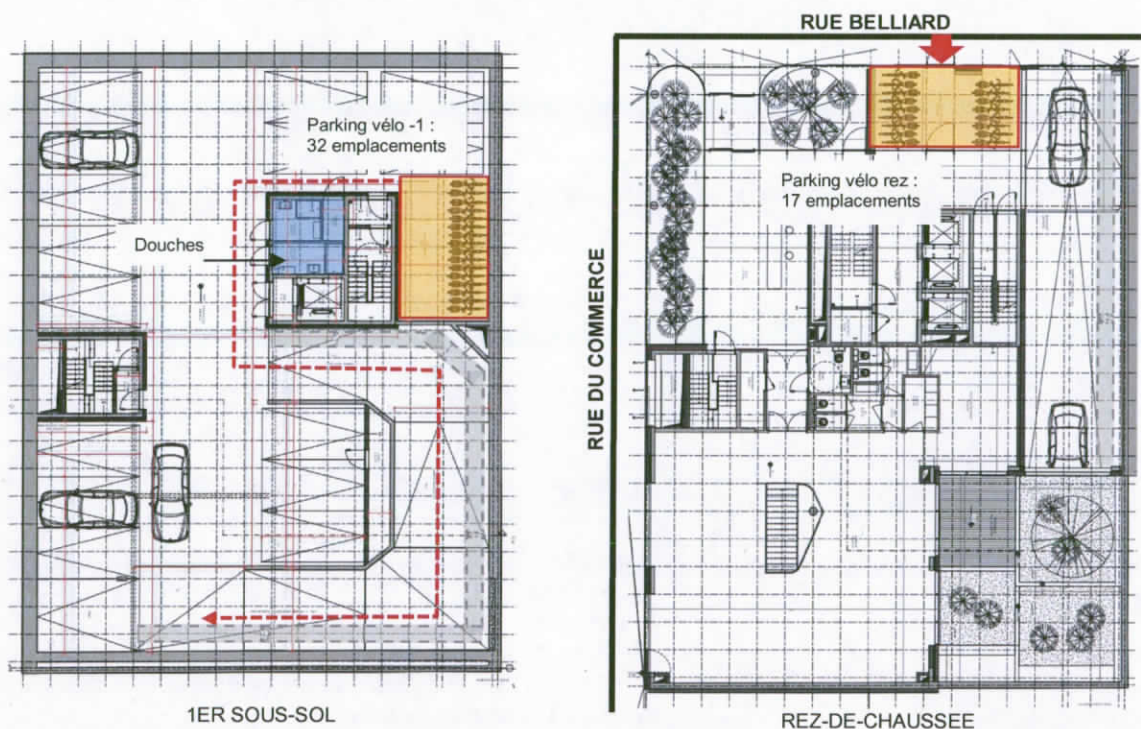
Accès Vélos, Parkings vélos rez-de-chaussée et -1 et douches au -1 (Source : A&B 2018)
